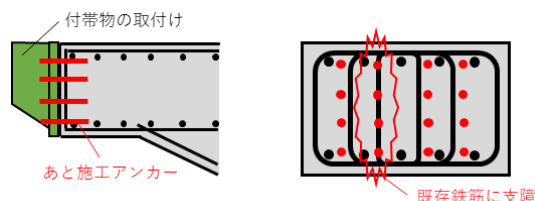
あと施工アンカー工法の課題（既存配筋への支障）
